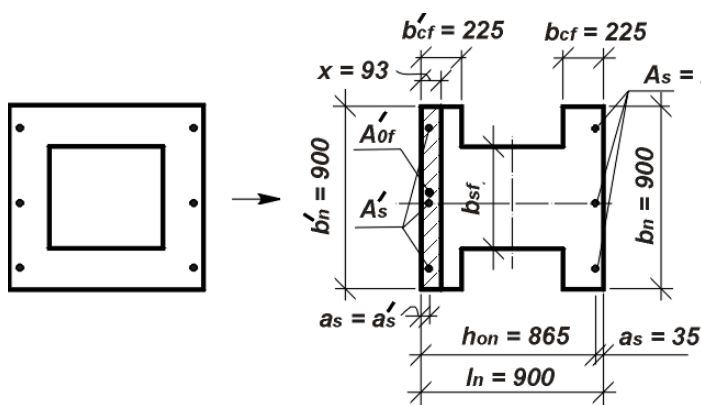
К расчету продольной арматуры подколонника по сечению I-I
